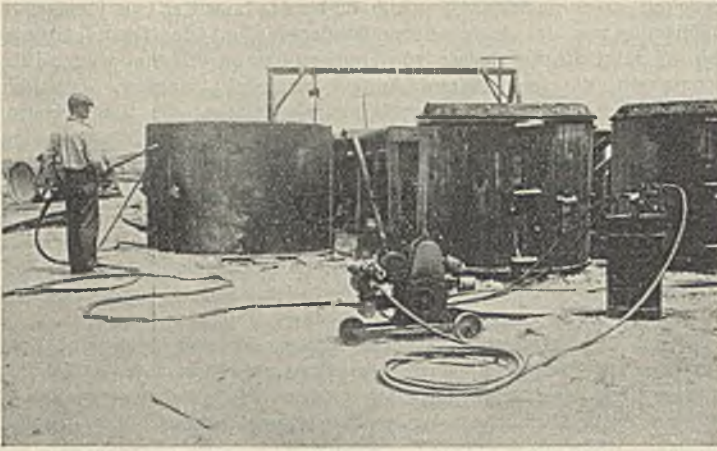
Behandlung von 1524 mm weiten Eisenbetonrohren nach dem Hunt-Verfahren in Sayreville, New Jersey.
